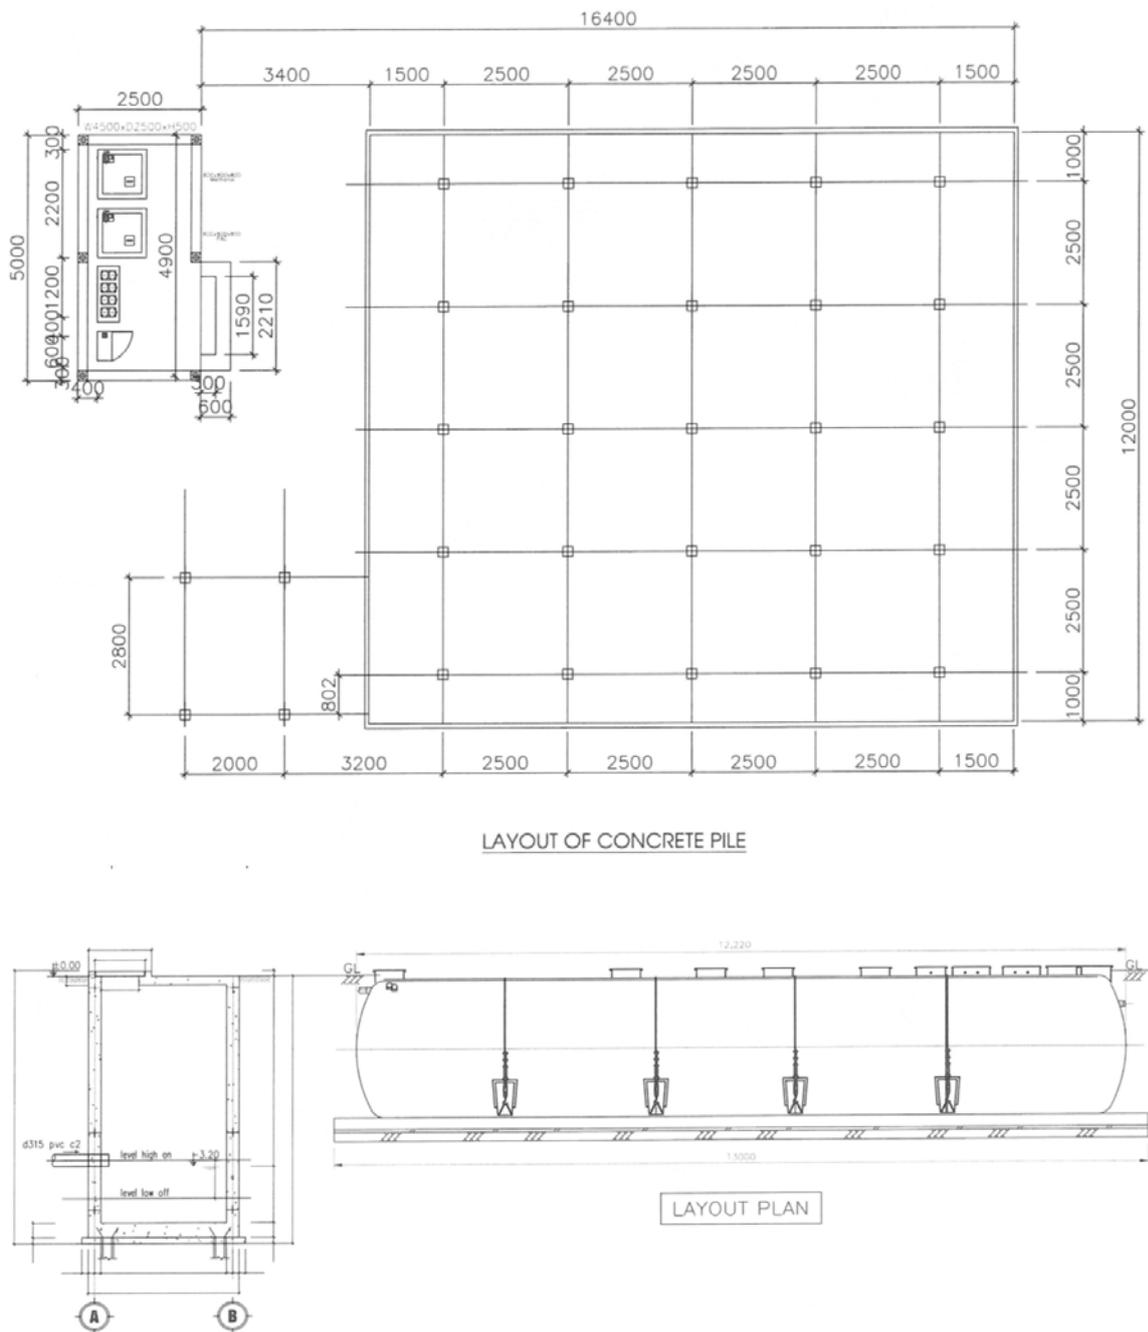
大型槽設置工事の工事設計図（平面図および断面図）
